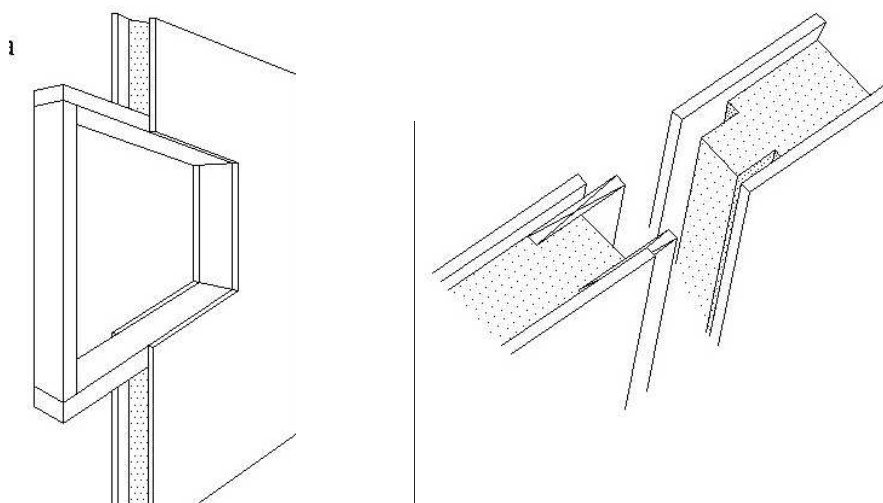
CONJUNTO SANTA CLARA: DETALHE DE ENCAIXE DAS JANELAS COM O PAINEL E ENTRE PAINÉIS.
